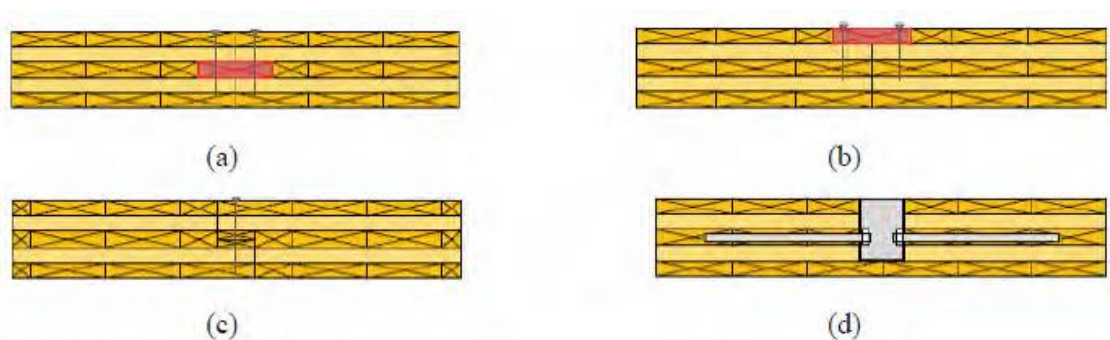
Ligação do tipo parede – parede (||): (a) Ligação com uma lingueta; (b) Ligação com cobrejunta em madeira; (c) Ligação em corte de meia-madeira; (d) sistema de ligação com um tubo (Mandegarian e Milev, 2010).
